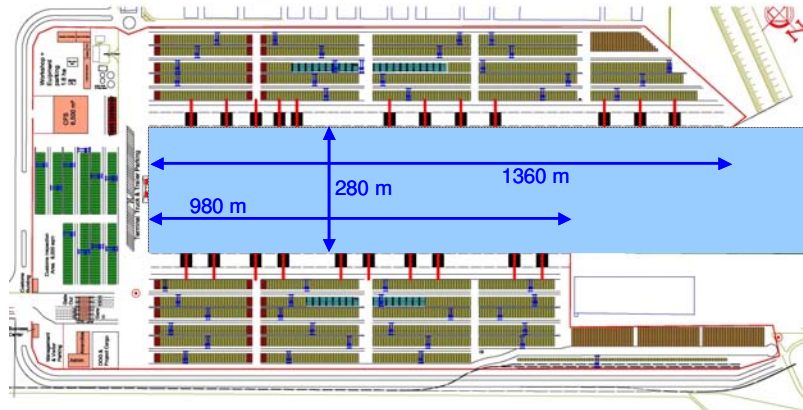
Terminallayout „Damietta International Port“ gemäß Masterplan
